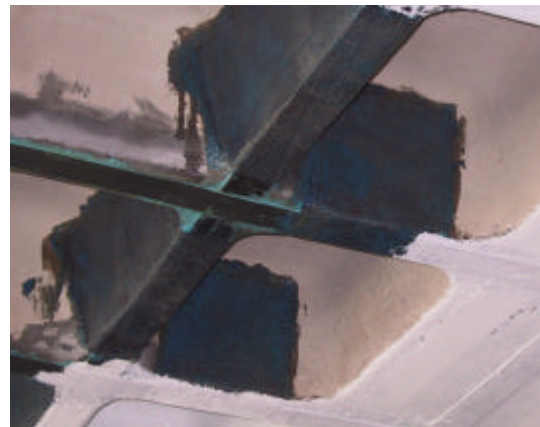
Disposición a cortante, colaborando en el anclaje longitudinal del refuerzo a flexión, vista general.
